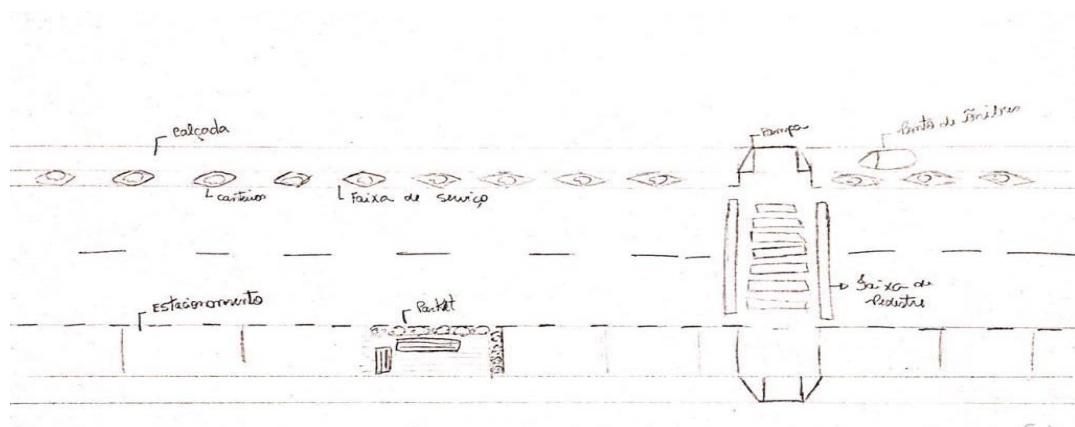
Croqui da intervenção em planta baixa da Rodovia Othovarino Duarte Santos.
